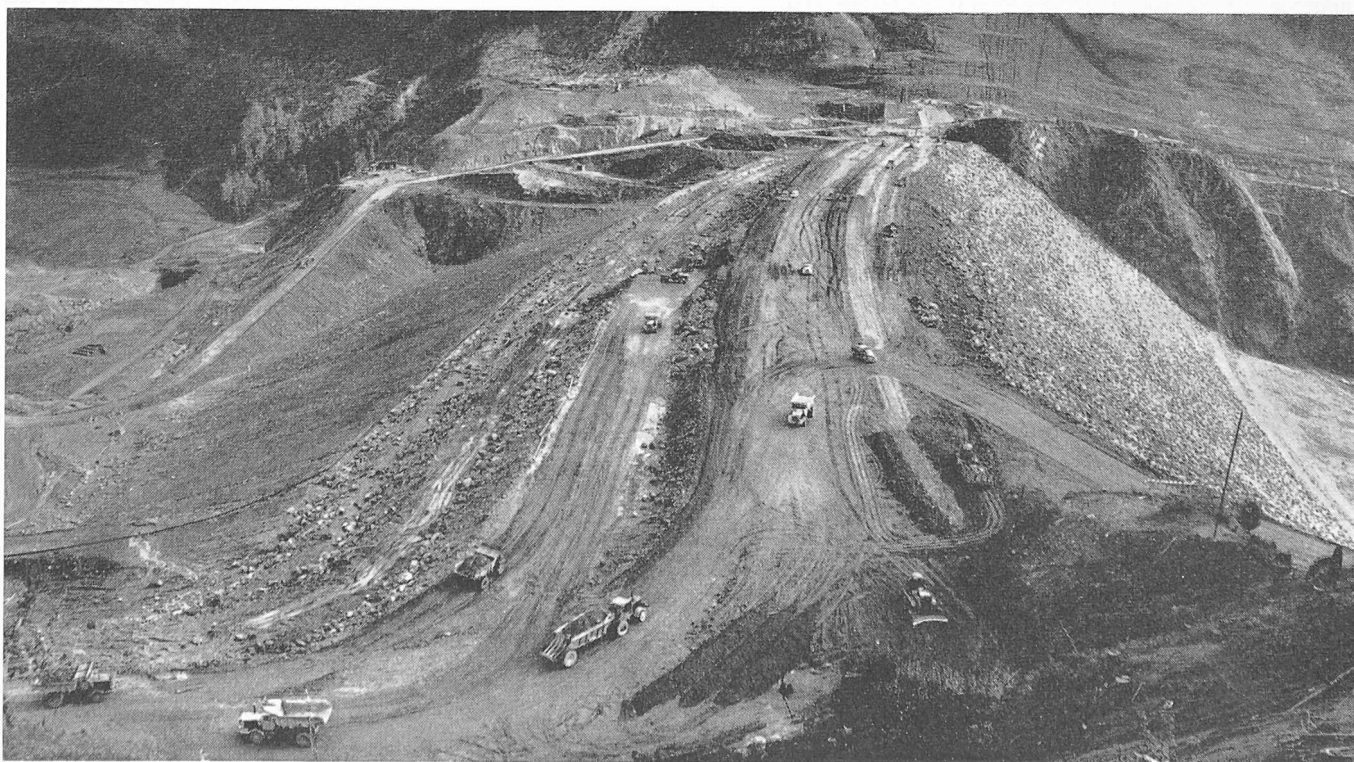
Einbau des Swift-Dammes vom rechten Widerlager aus (25. 9. 1958)
